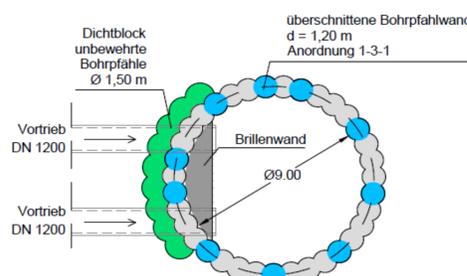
Grundriss, Variante B2, Zielgrube, Querung (Q1)
